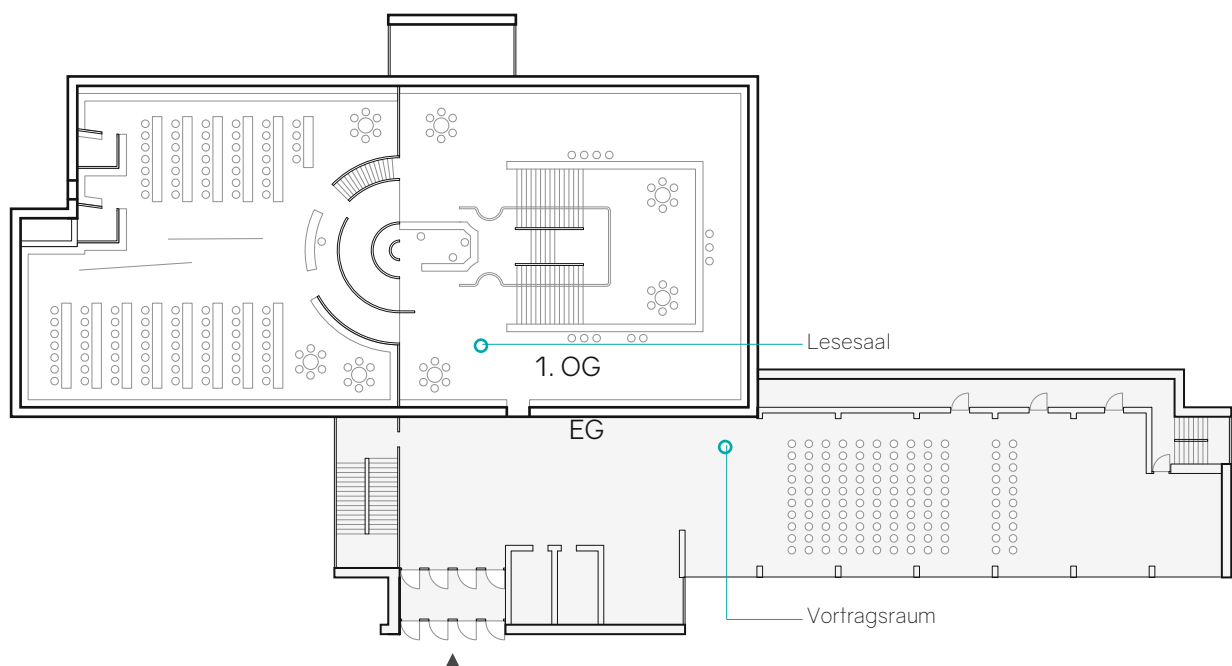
Grundriss Stiftsbibliothek Viipuri
